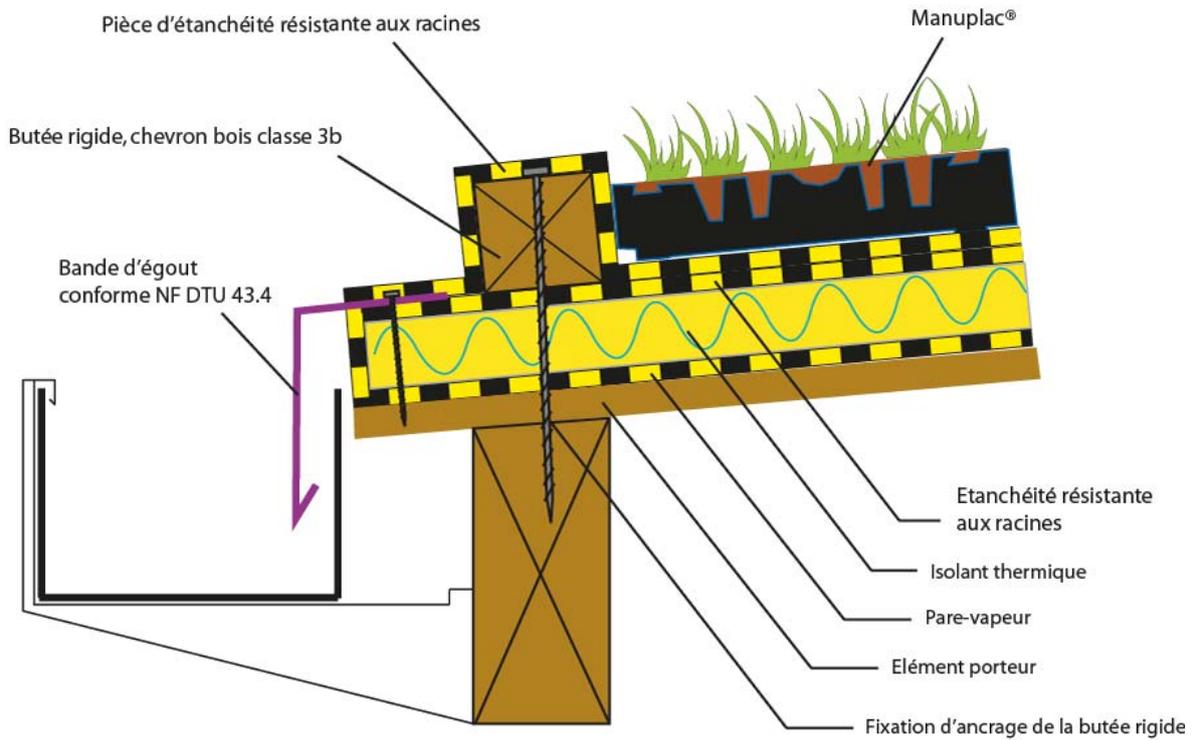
Exemple de dispositif de retenue par chevrons bois pour système Manuplac® sur étanchéité bitumineuse
